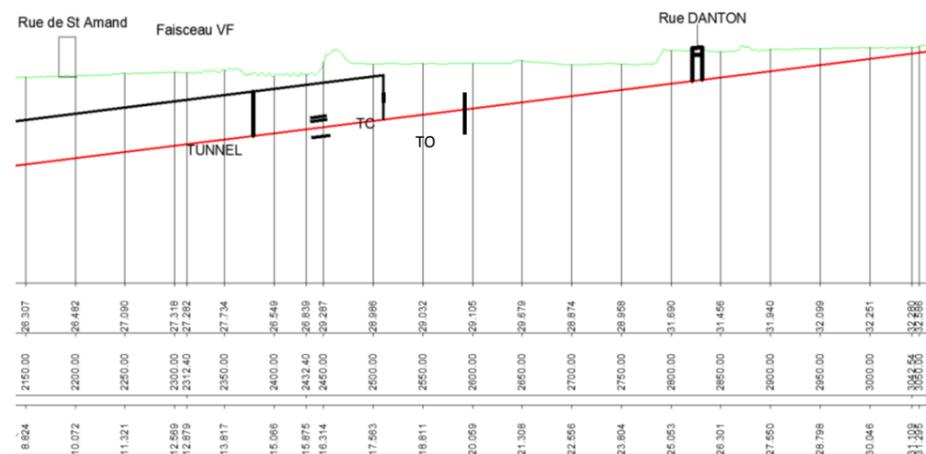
Implantation et profil en long de la tranchée de la tête Sud du tunnel
